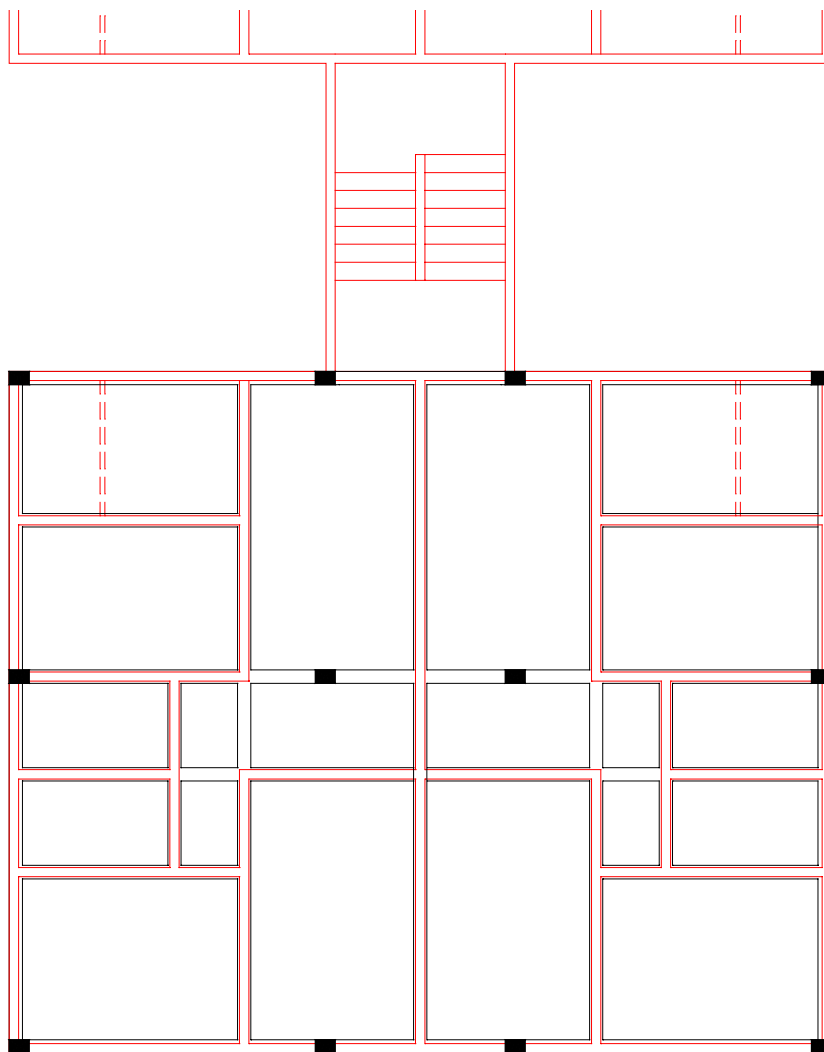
Prédio “C” – Opção 3 – Superposição das alvenarias do pavimento tipo sobre a estrutura
